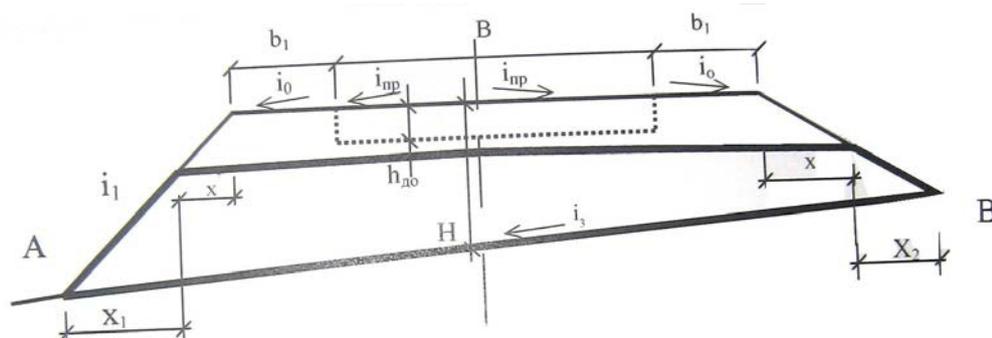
Схема поперечного профиля земляного полотна в насыпи
